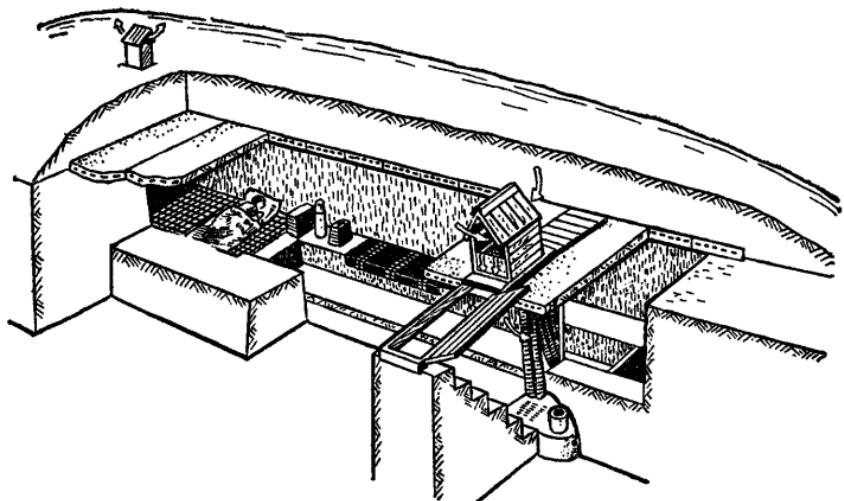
Укрытие без одежды крутостей с перекрытием из железобетонных плит (ослабляет действие радиации в 300—400 раз; ширина площадки опоры плит на бровку откоса не менее 0,8 м)
